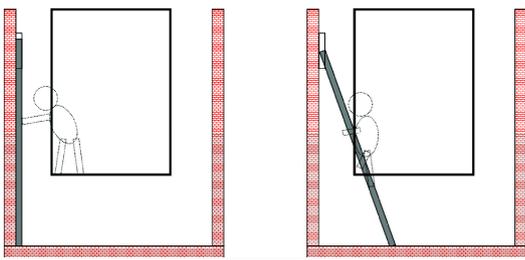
Ausschwenkbare Schachtgrubenleiter
